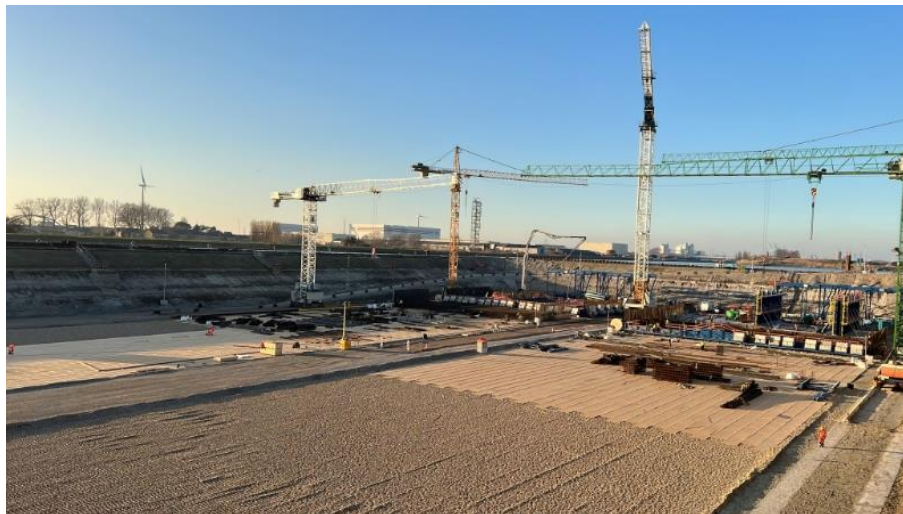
Estrutura de betão da Rijnlandroute Leiden
